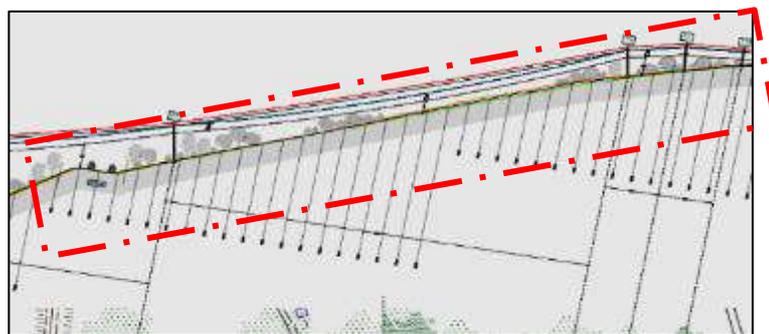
Sezione e planimetria del tratto di cabinovia oggetto di analisi
